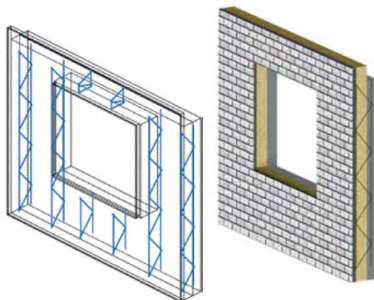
Схематическая конструкция стеновой панели / Schematic construction of wall panel
